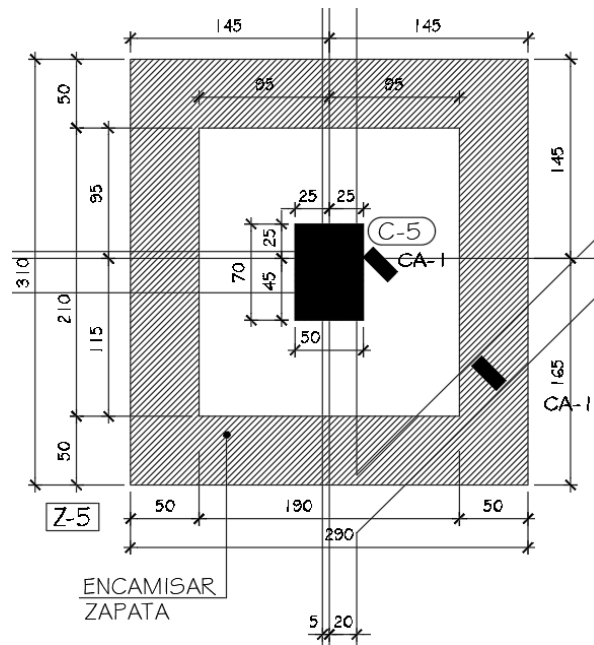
Vista en planta de la zapata Z5 para encamisado (Solarte y CIA, 2014).
